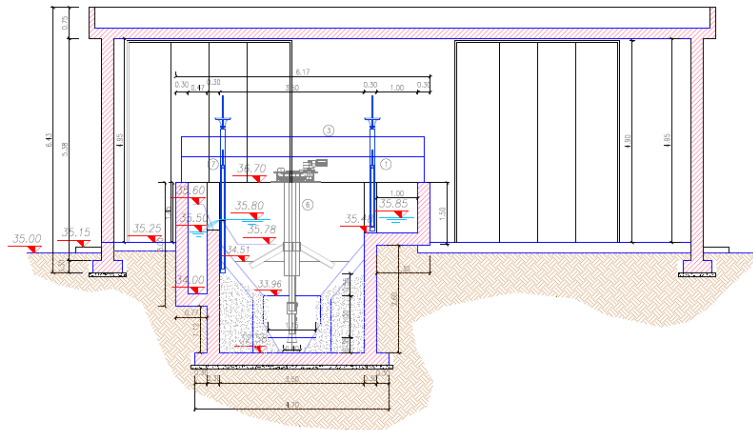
Pianta e sezioni nuovo edificio pretrattamenti
